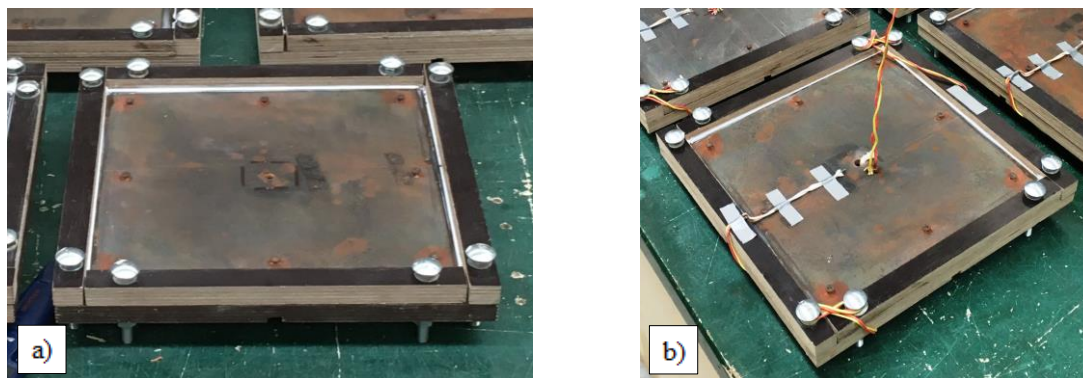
Provede: a) Parafusos soldados na chapa metálica; b) Provede instrumentado com os termopares.
